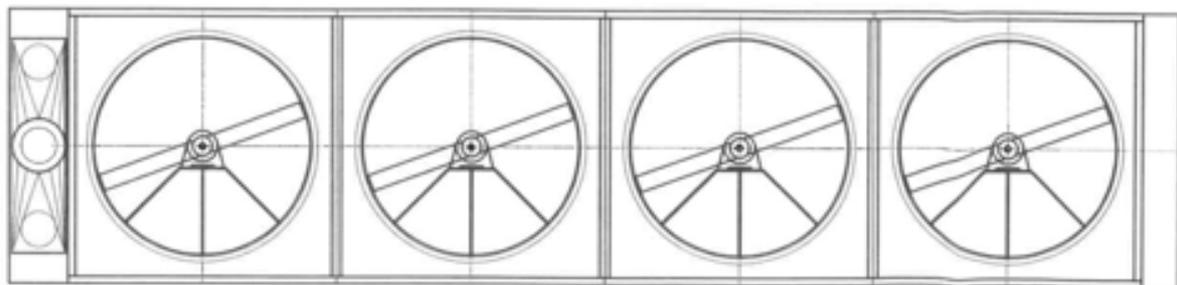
schema planimetrico aerocondensatore, marca "Carrera Impianti" - modello 4800.
